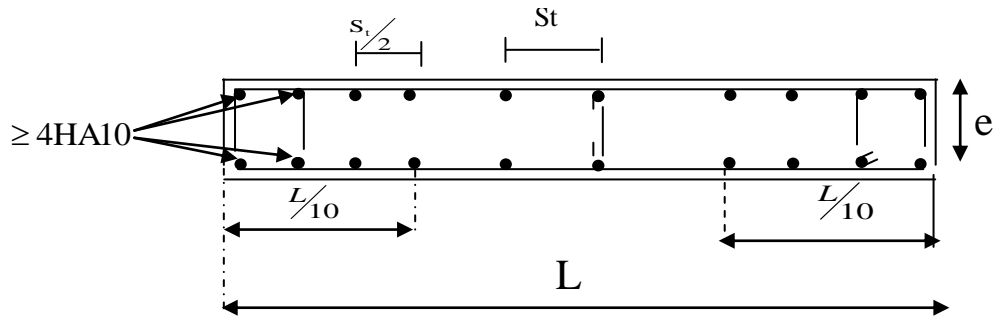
Disposition des armatures verticales dans les voiles.
